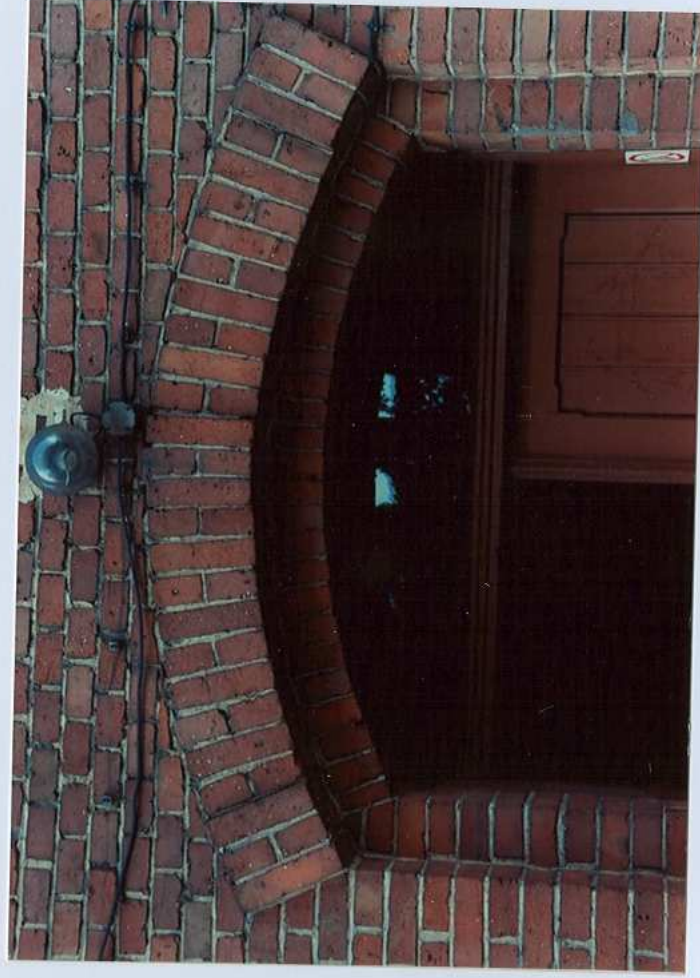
Drzwi wejściowe – elewacja wschodnia.
